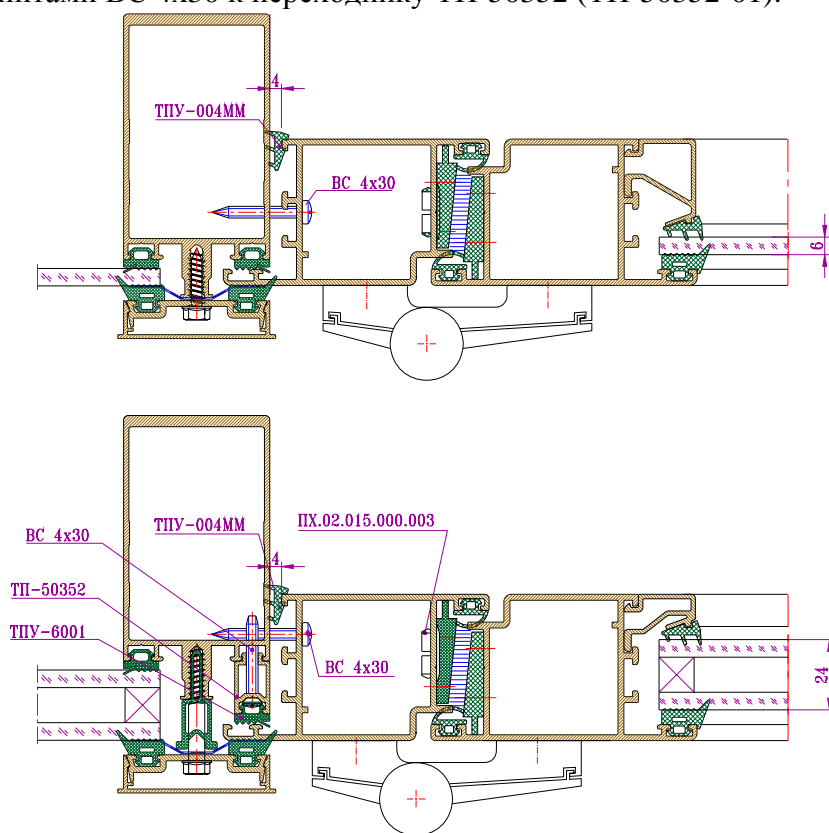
Установка и крепление двери со стеклом, стеклопакетом в витраж
